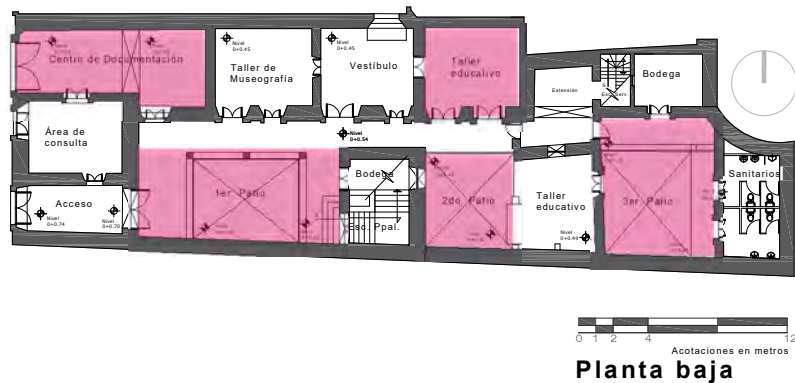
ubicación de los espacios a monitorear en planta baja
